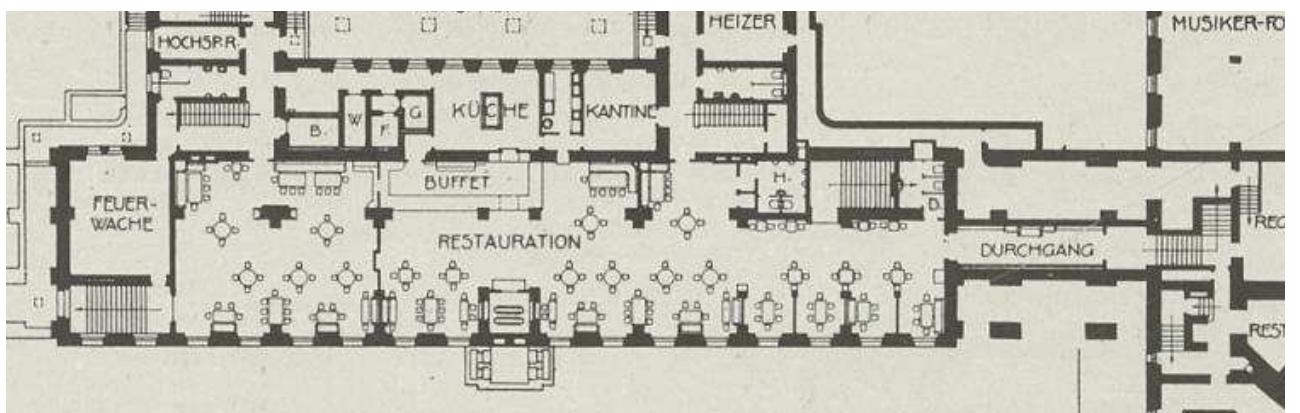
10. Ausschnitt Grundriss Sockelgeschoss
